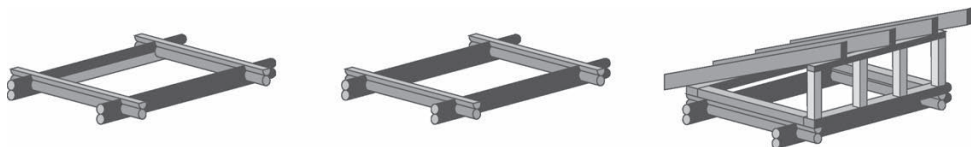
Перекрытие под кровлю с установкой отдельного каркаса
